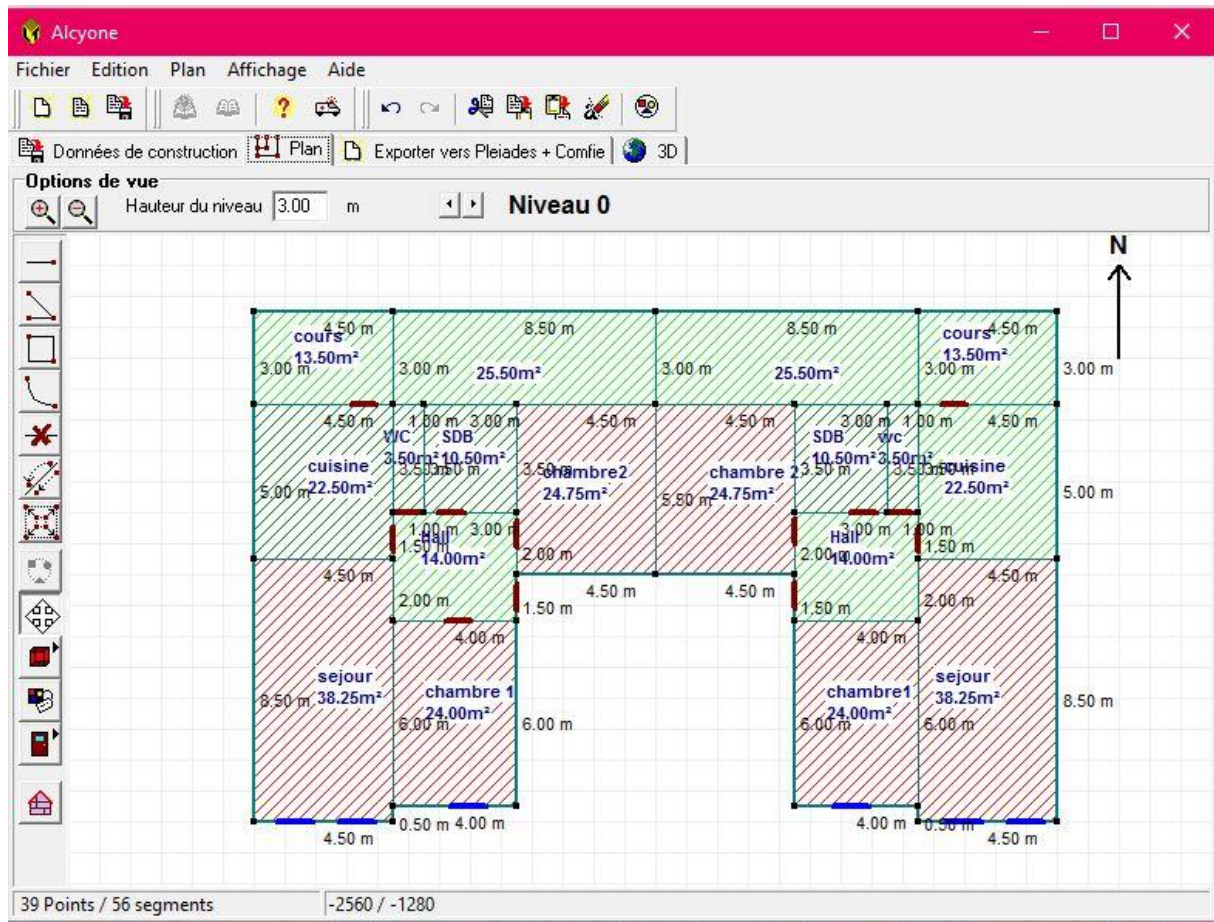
plan du 1^{er} étage sur alcyone (Mostaganem)
